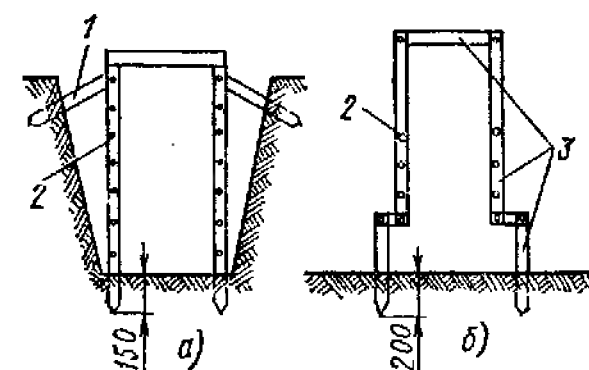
Шаблоны для кладки бутовых лептчатых фундаментов:
